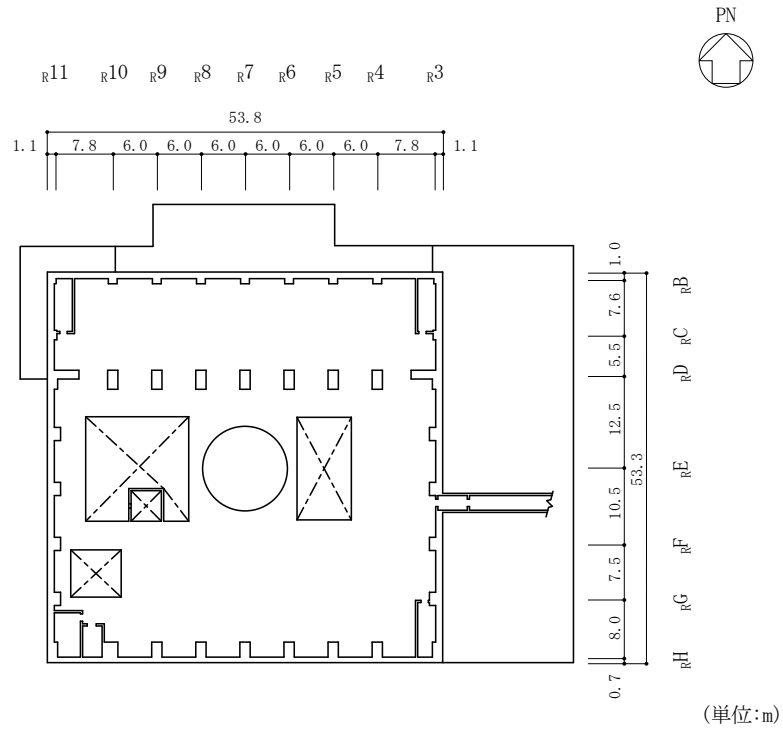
(7) 原子炉建物の概略平面図 (EL 42.8m)
